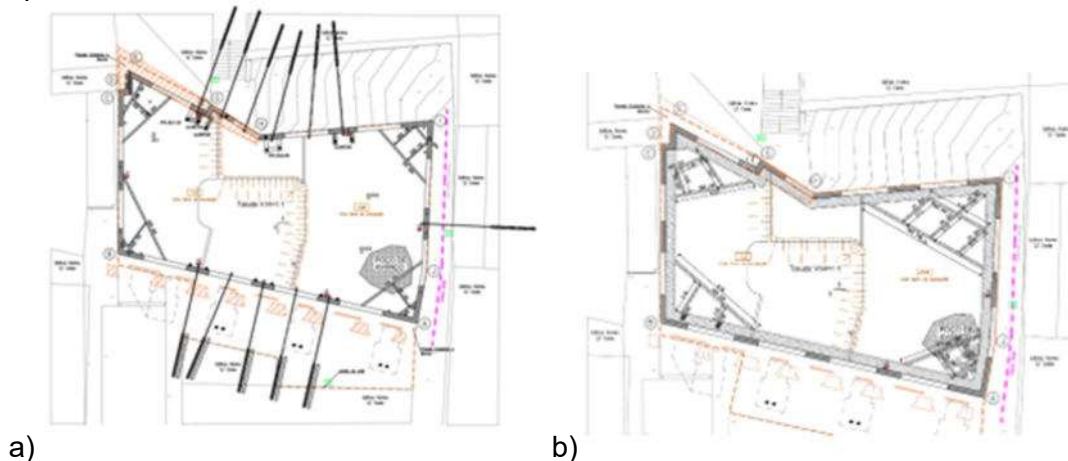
Planta de e contenção periférica a) primeiro nível de escavação b) níveis inferiores.
